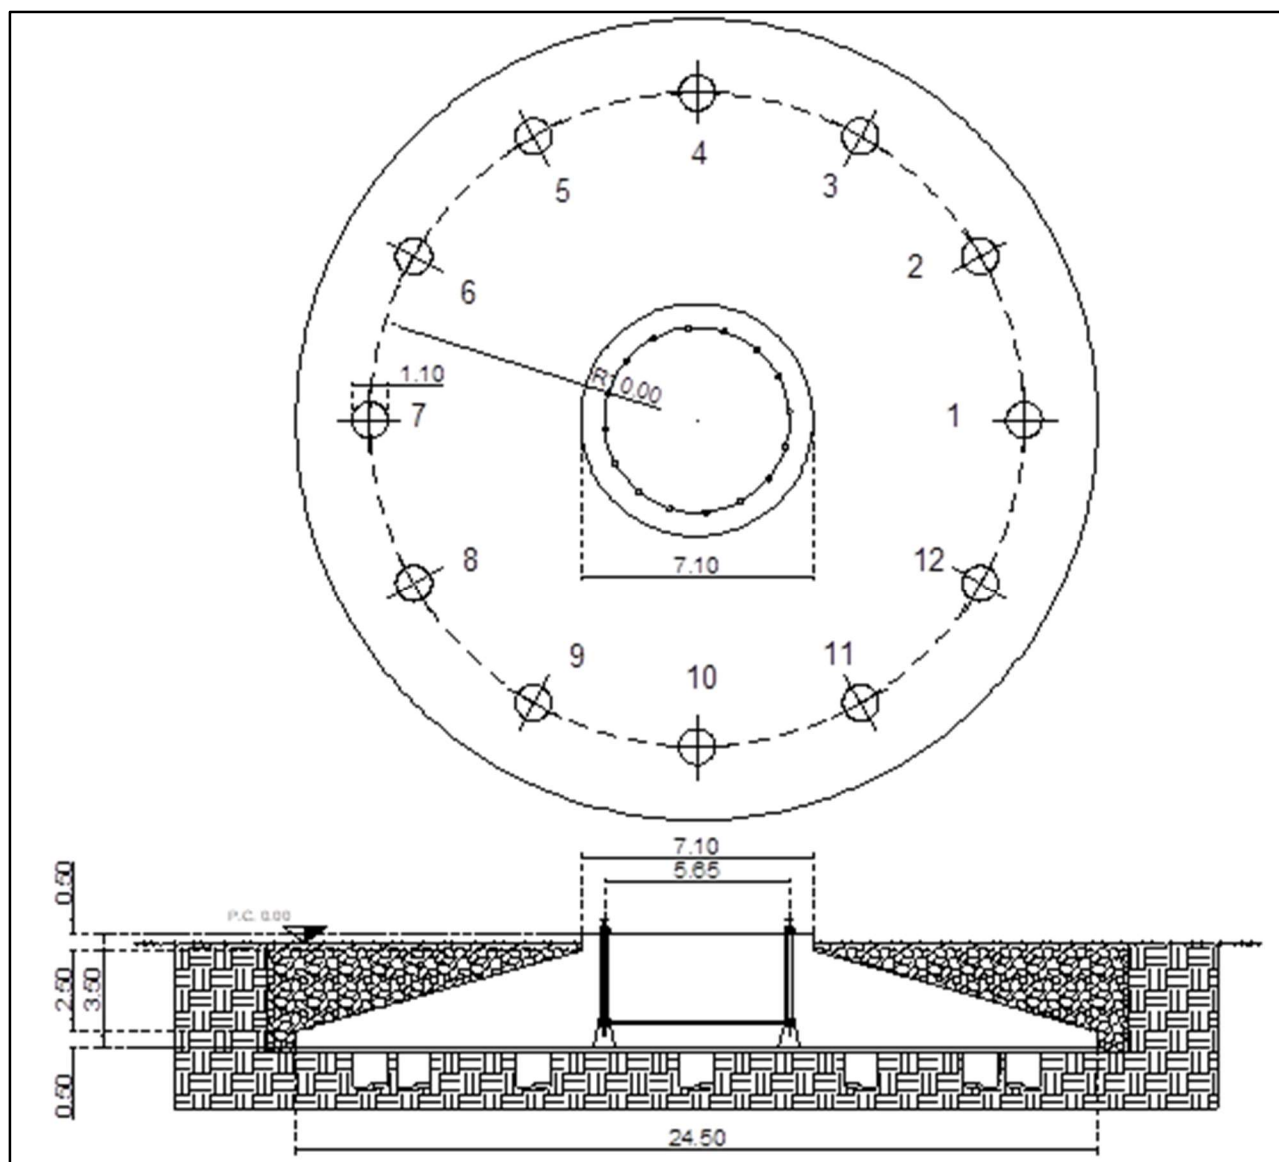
Dettaglio pianta e sezione fondazione
